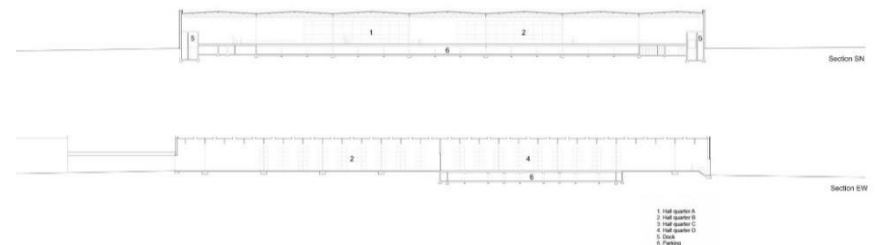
Fuente: Fotografía de SANAA (secciones transversal y longitudinal).
